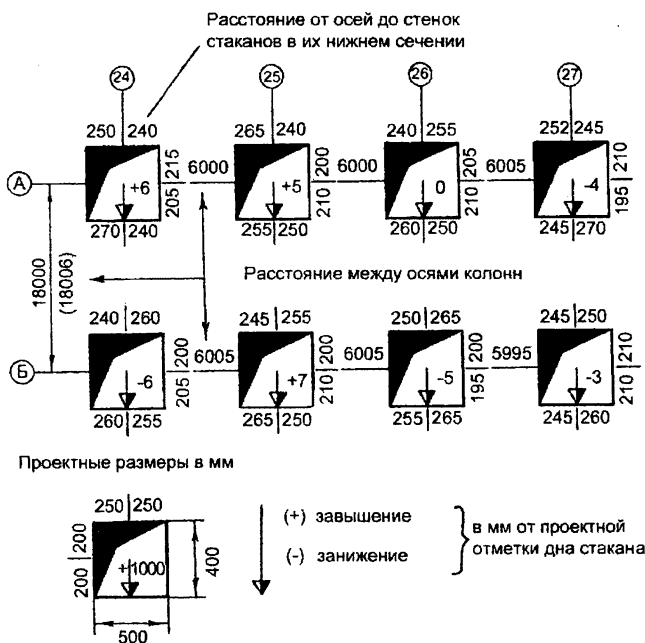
Исполнительная схема нижнего сечения фундаментов – стаканов под железобетонные колонны
